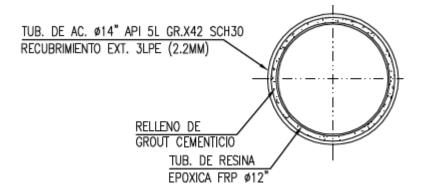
Sistema de tuberías de paredes múltiples, tamaño 12"x 14"
